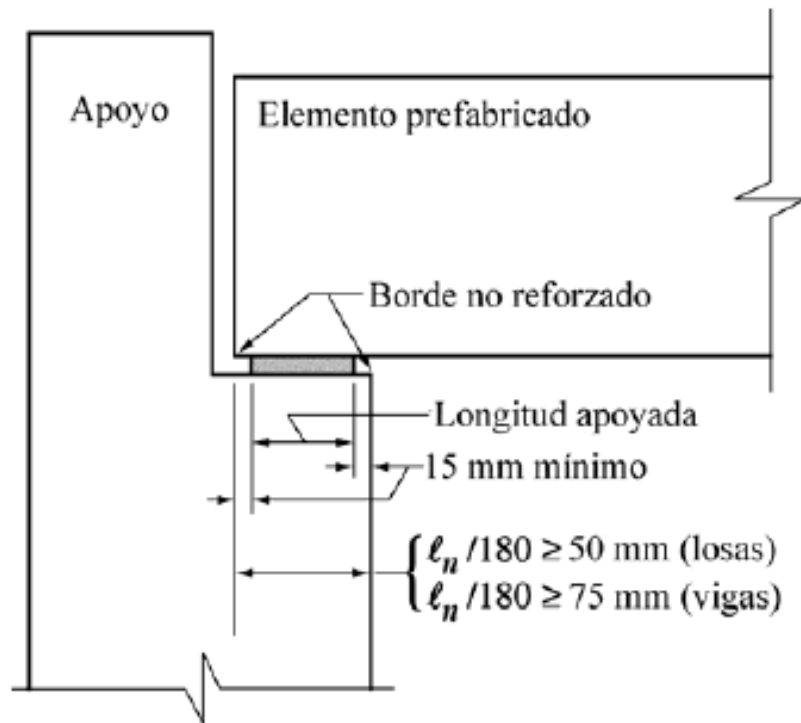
Longitud de apoyo. Adaptado de: ACI Committe 318 (2014)
